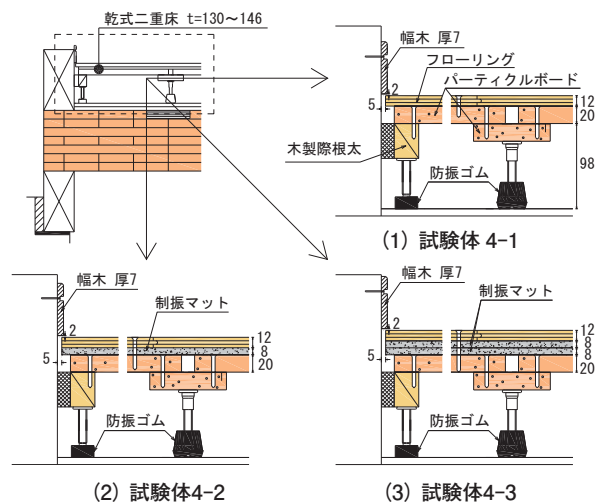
試験体4-1 ~ 4-3の乾式二重床の断面図(寸法単位:mm)
